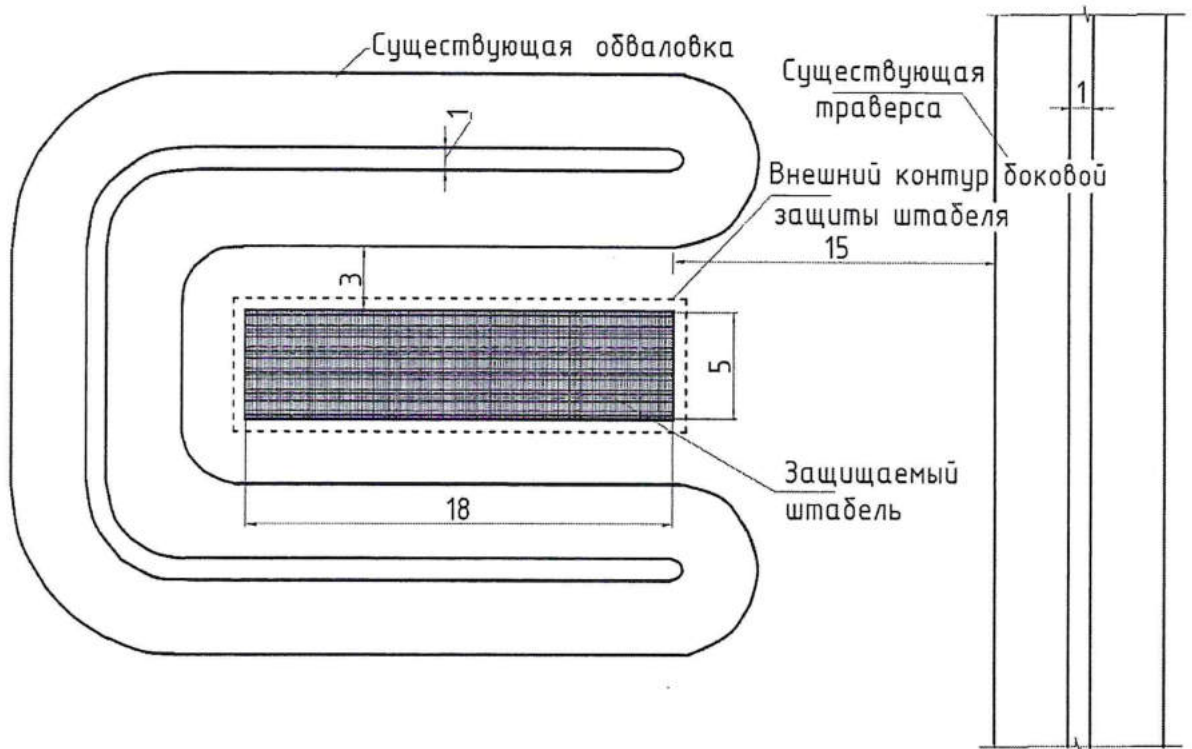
Схема устройства дополнительной боковой защиты штабеля с боеприпасами
